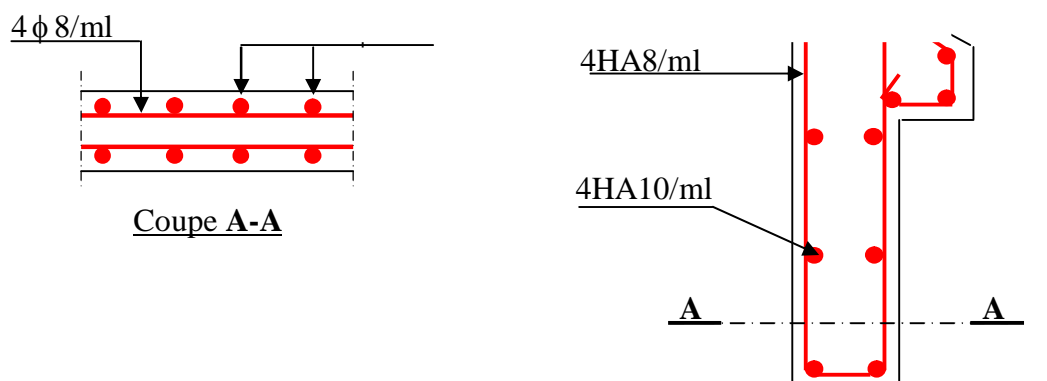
Schéma de ferrailage de l'acrotère type 02 et 03et04.
